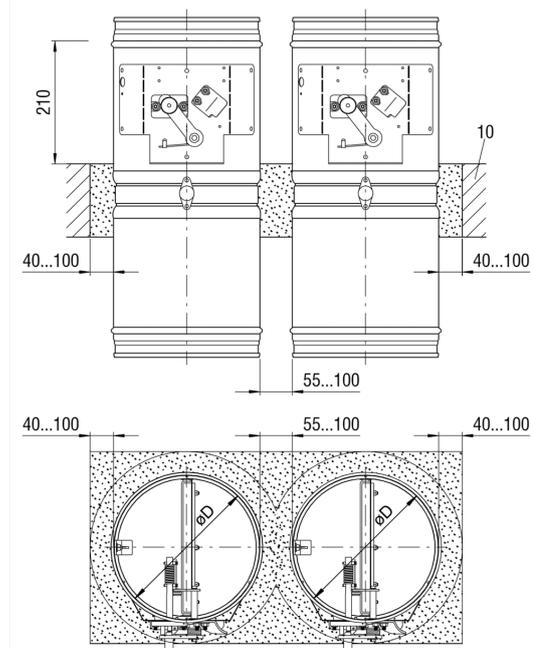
Nasseinbau verringerter Abstand, massive Decken (Aussparung rund bzw. eckig)
